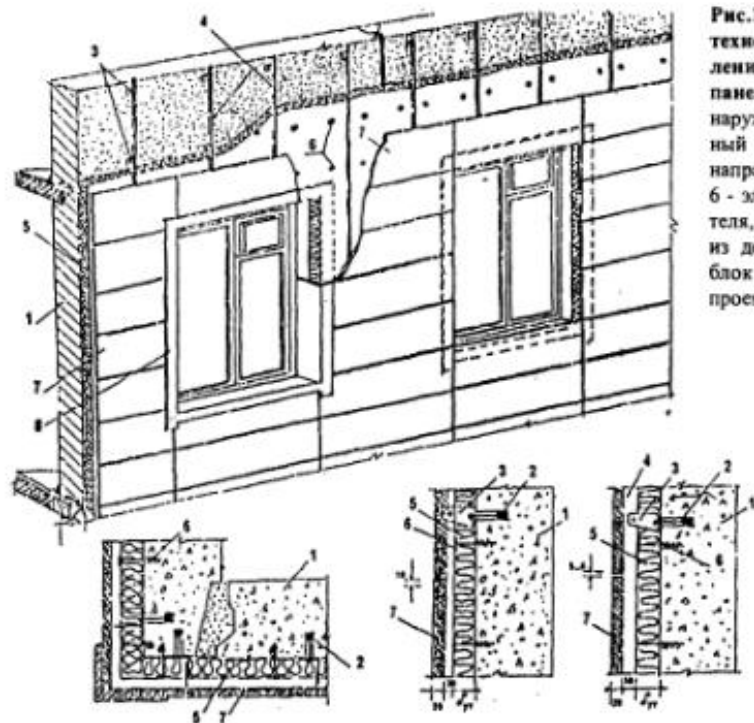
Конструктивно - технологическая схема утепления и облицовки фасада панельного здания: 1 - панель наружной стены, 2 - распорный анкер, 3 - кронштейн, 4 - направляющая, 5 - утеплитель, 6 - элемент крепления утеплителя, 7 - облицовочные плиты из декоративного бетона, 8 - блок обрамления оконного проема
